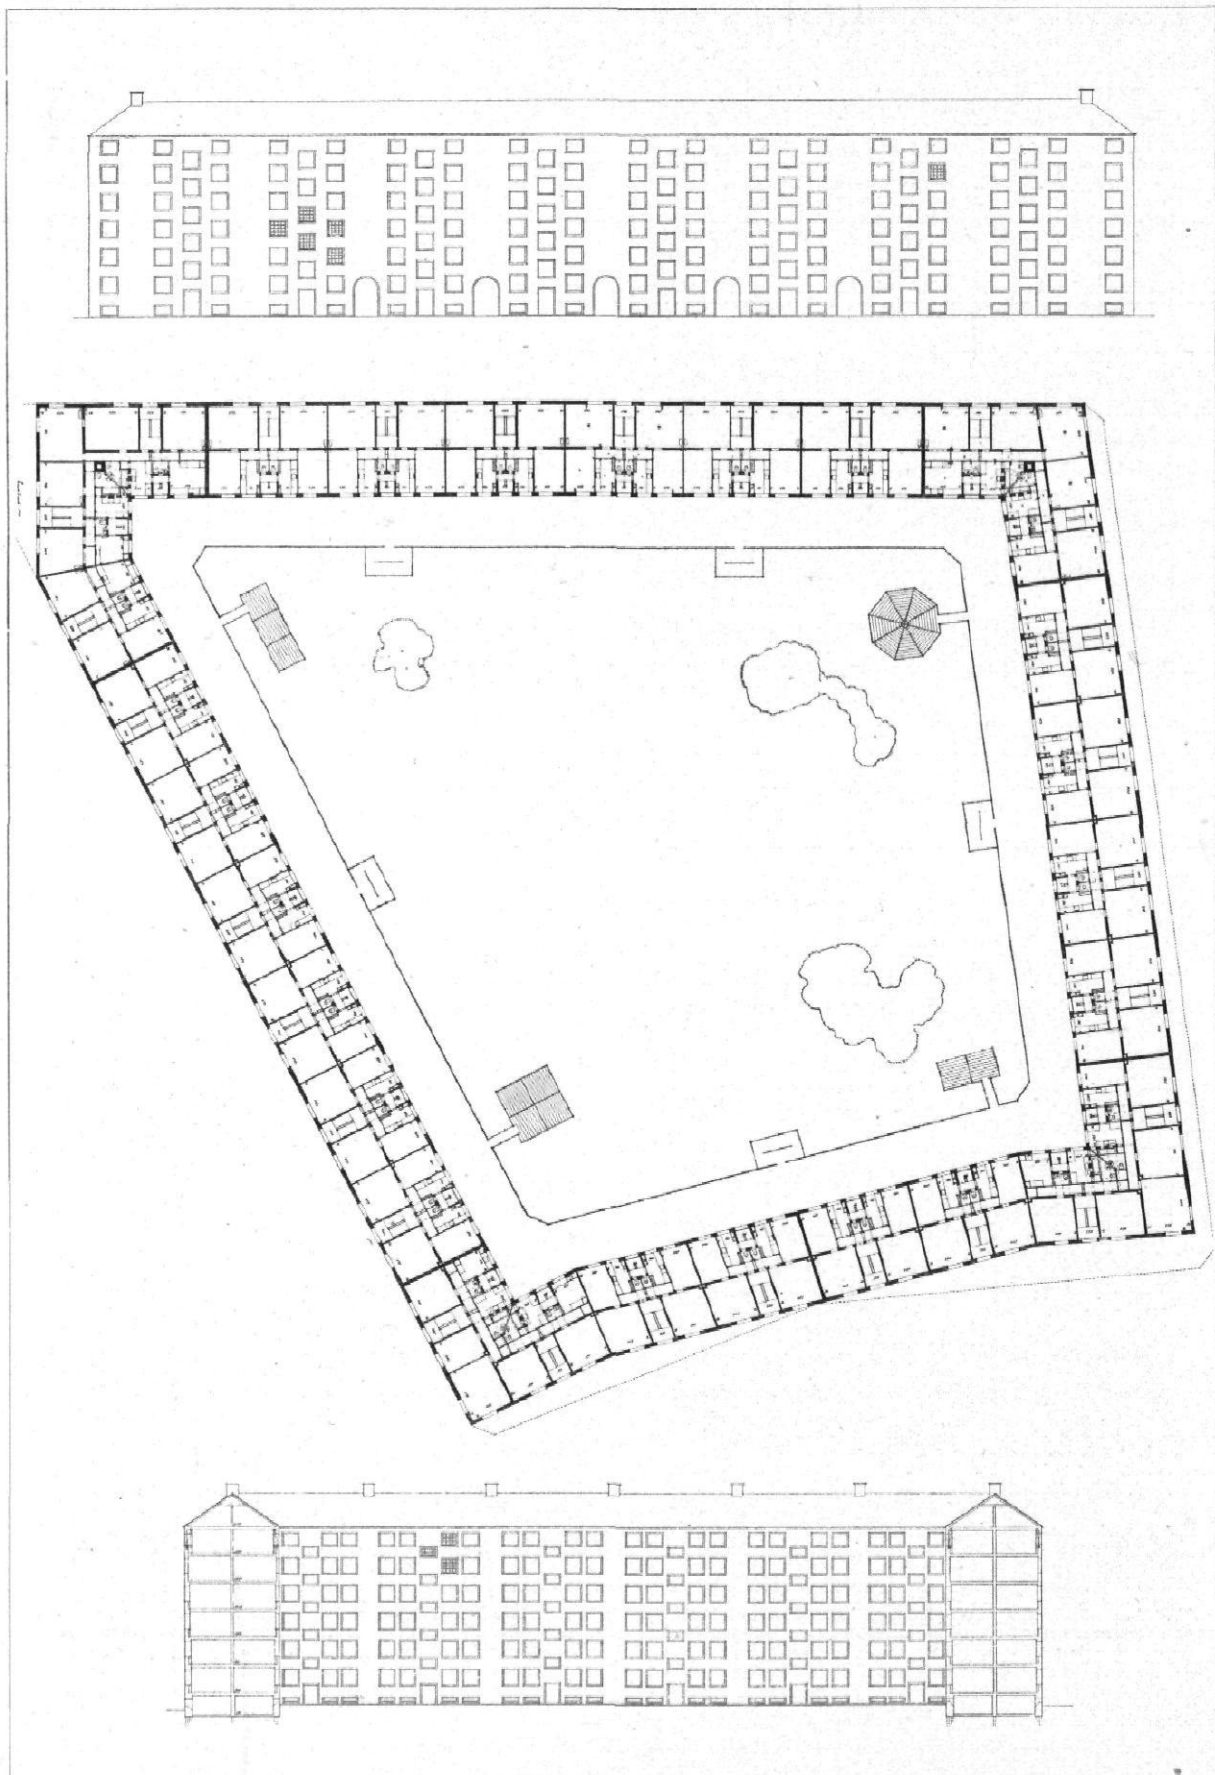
/ Mietsblock in Kopenhagen, Artillerivej | Grundriss und Fassaden. 1:800
